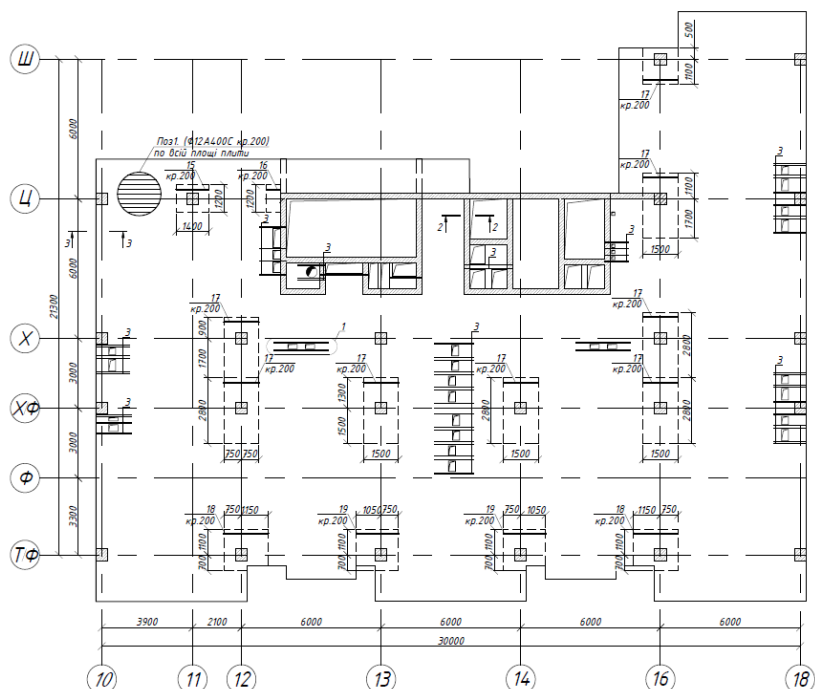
Схема розташування верхньої арматури вздовж осі Х.
